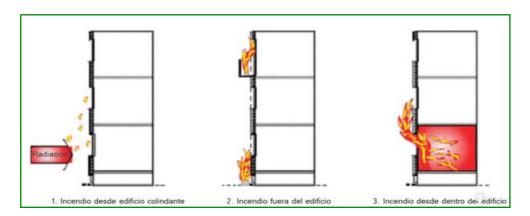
Mecanismo de propagación del fuego en fachadas. Fuente: Kotthoff y Riemesch.
